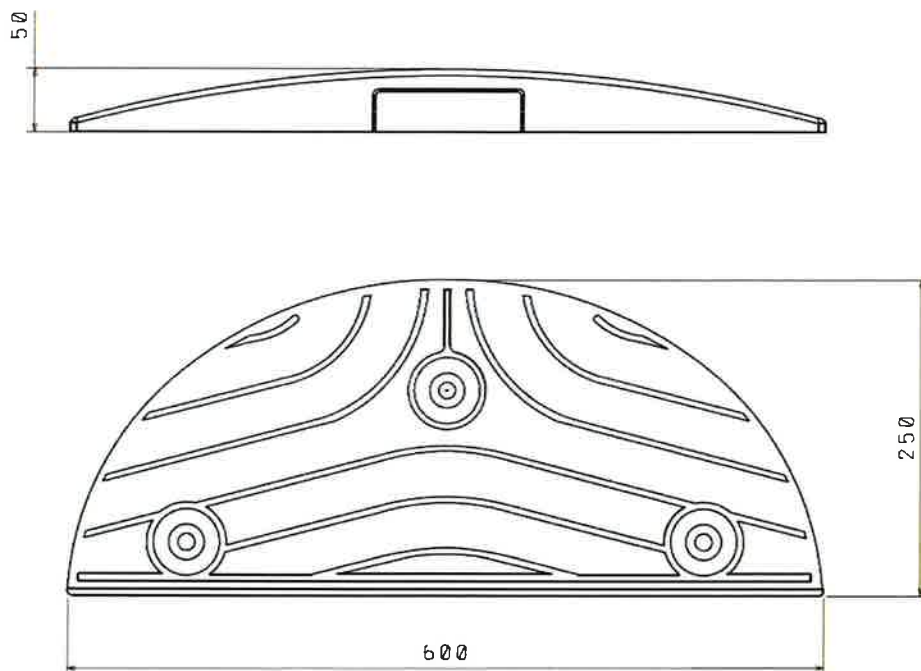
Element podstawowy progu podrzutowego PpVB-3/60
